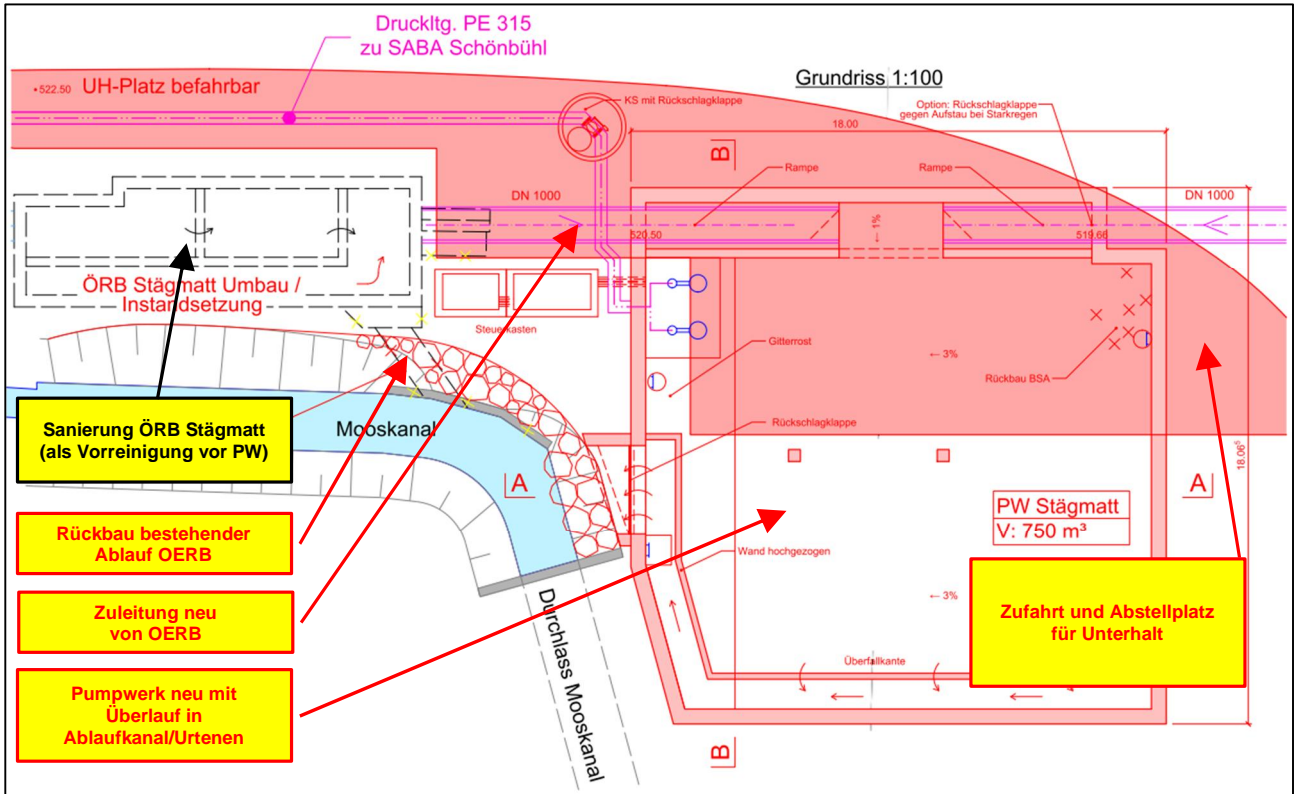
Pumpbecken Stägmatt neu – Grundriss
